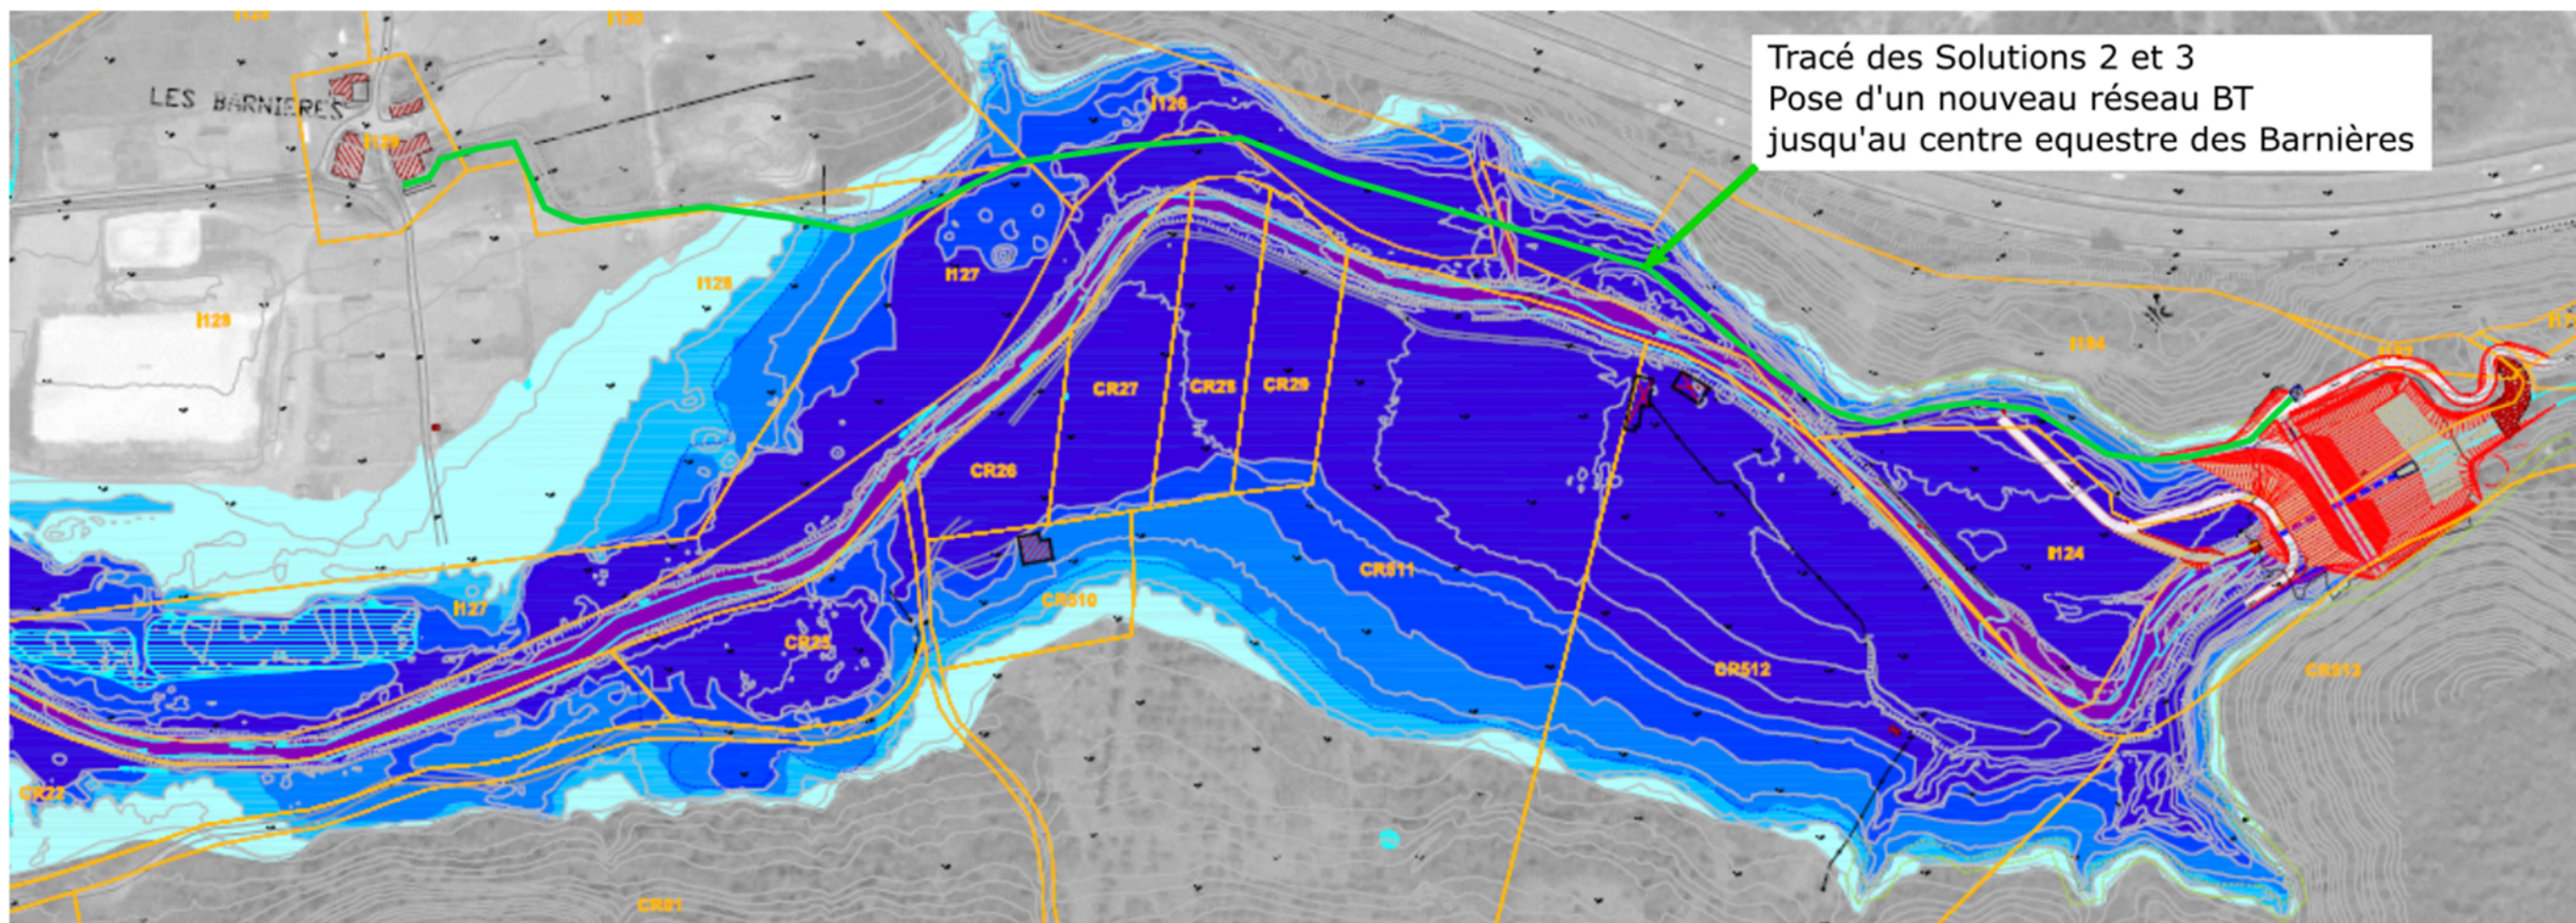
Plan de principe de la solution 3 sur fond de plan n°2 de l'AVP
